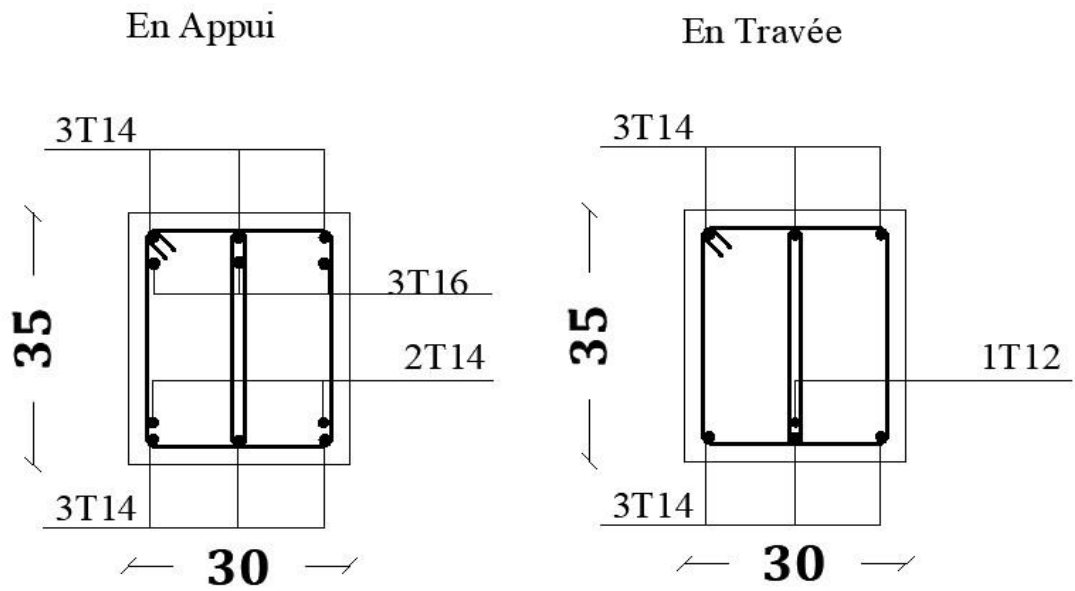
Schéma de ferrailage de la poutre secondaire 30x35
